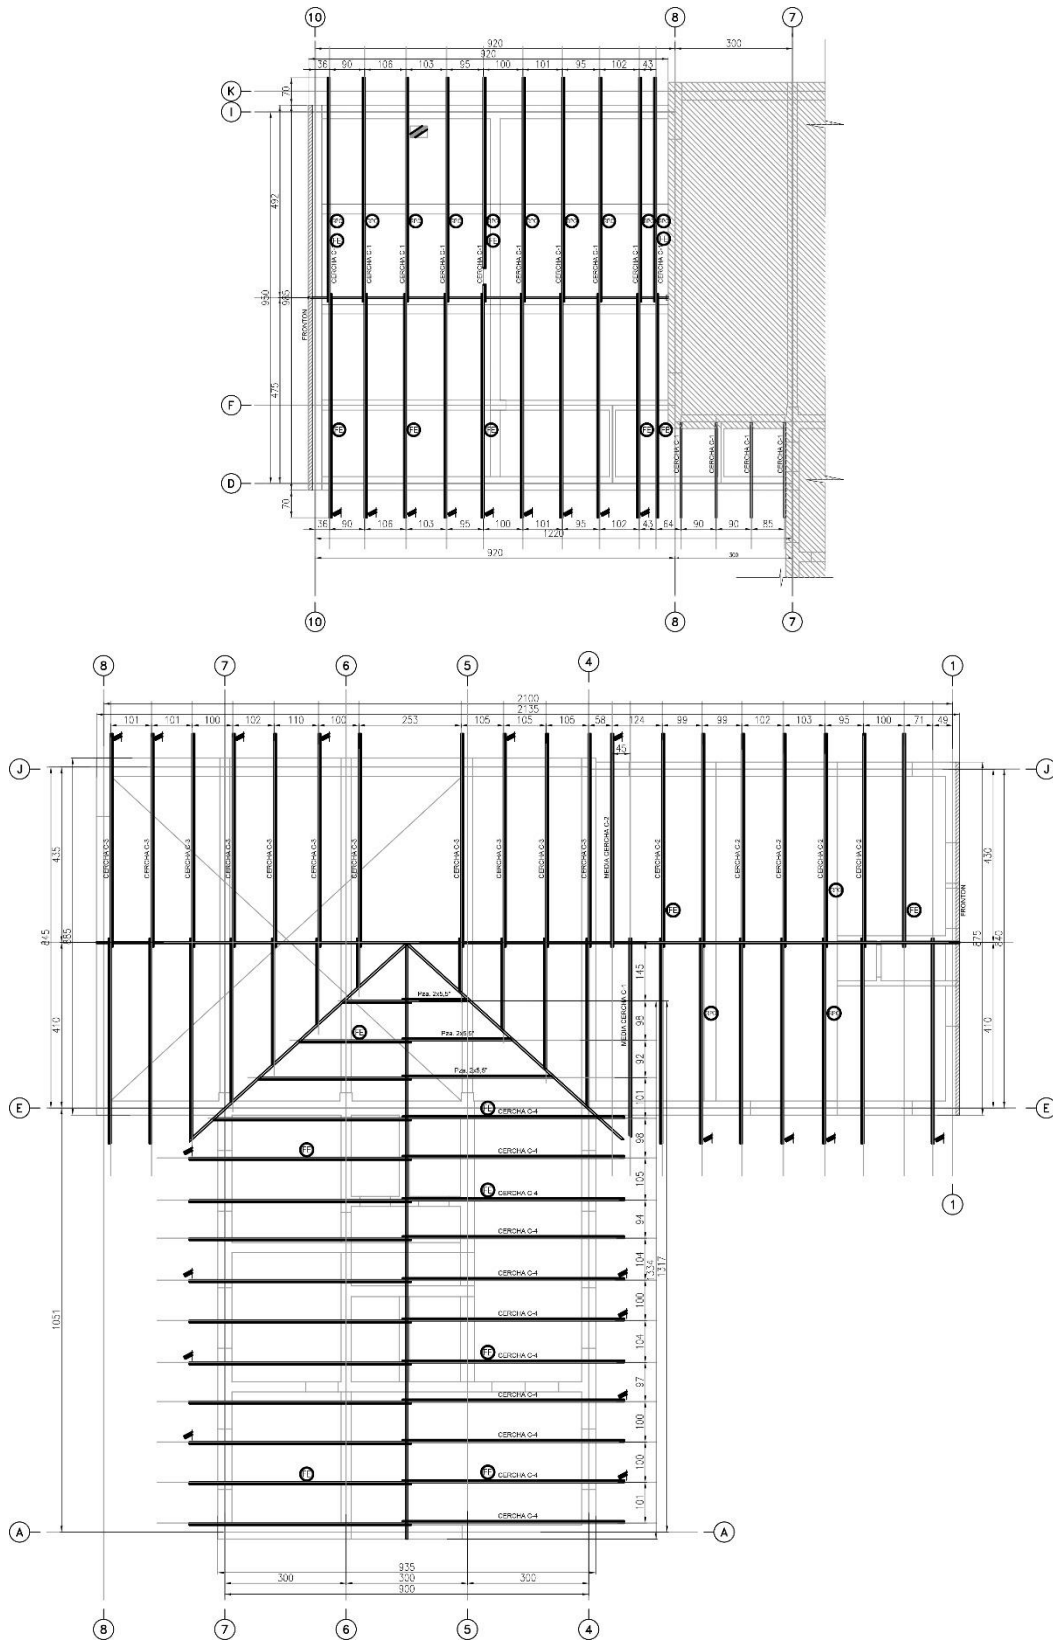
4 Planta techos, de Consultora OM&S, (arriba) 1º Nivel y (abajo) 2º Nivel.
